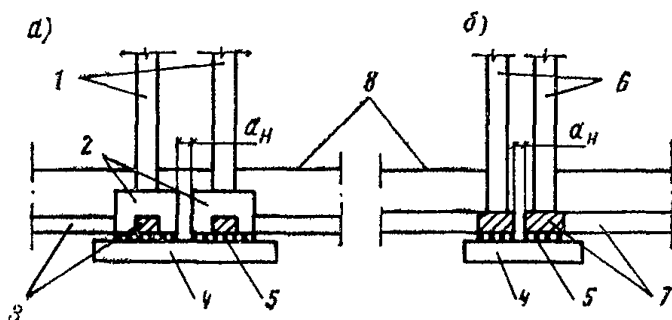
Устройство общей фундаментной плиты у вертикального деформационного шва каркасного (а) и бескаркасного (б) здания
